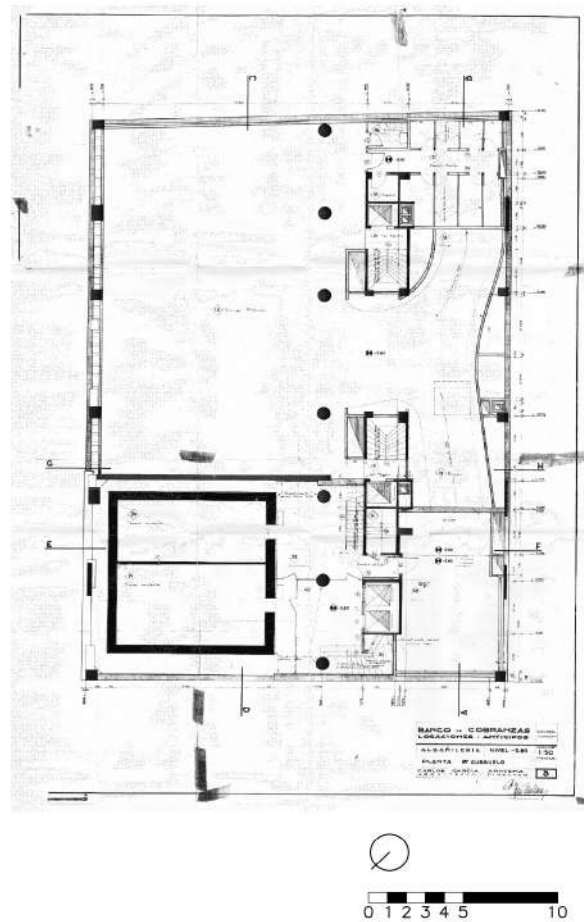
Planta del proyecto del primer subsuelo del BCLA, donde se aloja la bóveda. Se aprecia la regla estructural espacial que impone su disposición. La continuidad pasante de planta baja es interrumpida en este nivel por una pantalla que la separa del estacionamiento.
